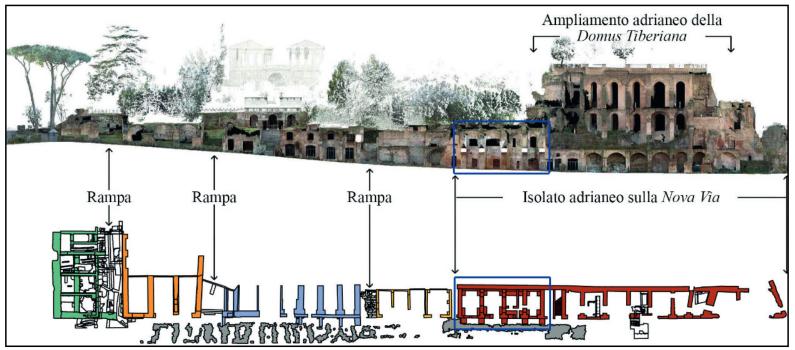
Planta y sección de la Domus Tiberiana, se aprecia en la parte derecha especies vegetales en la cubierta
